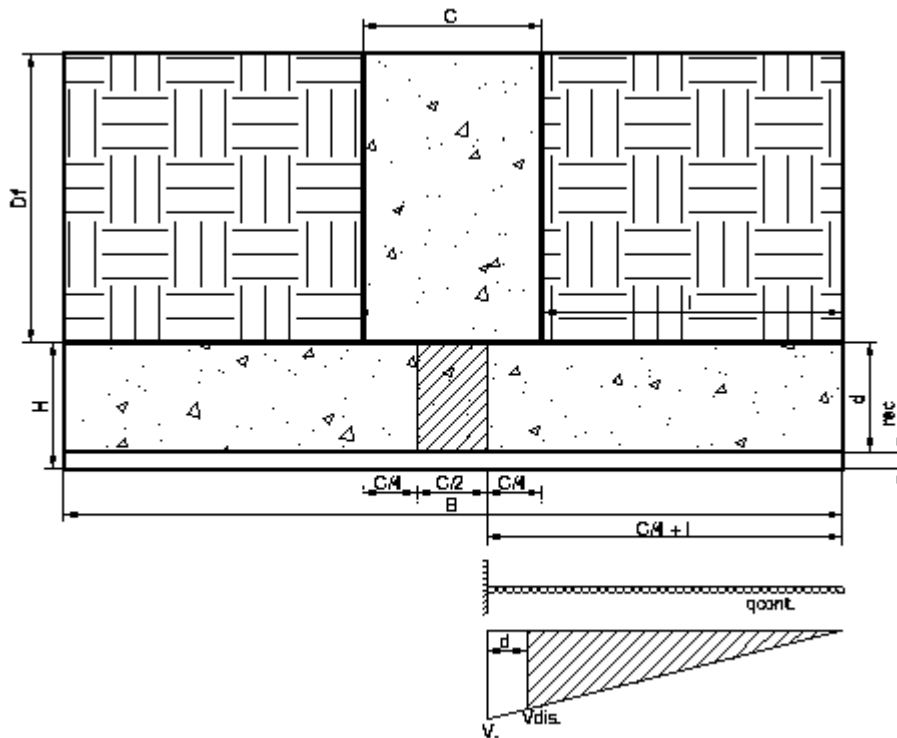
Elementos del diseño estructural de una zapata aislada central.
